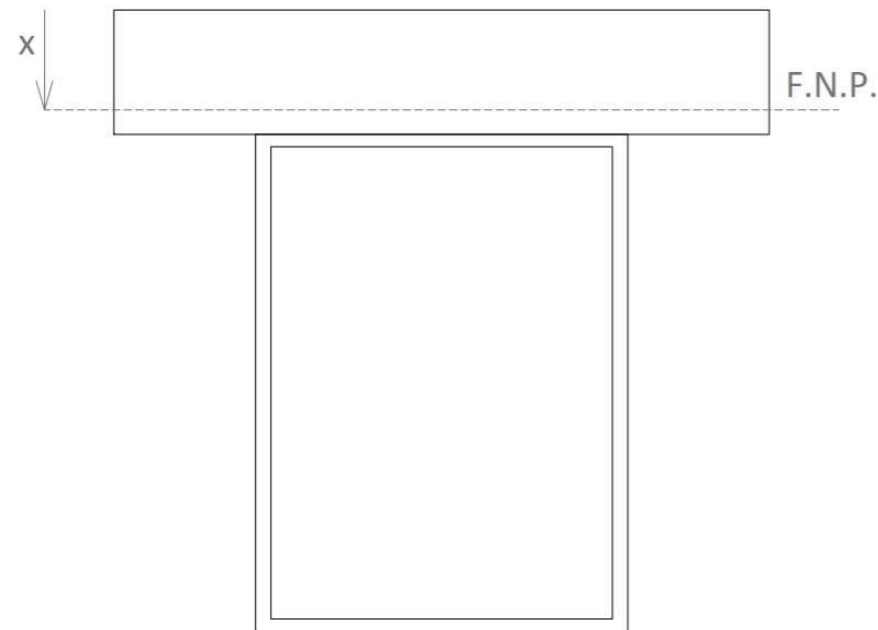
Fibra neutra plástica en la losa de hormigón de la riostra (fuente: elaboración propia)
